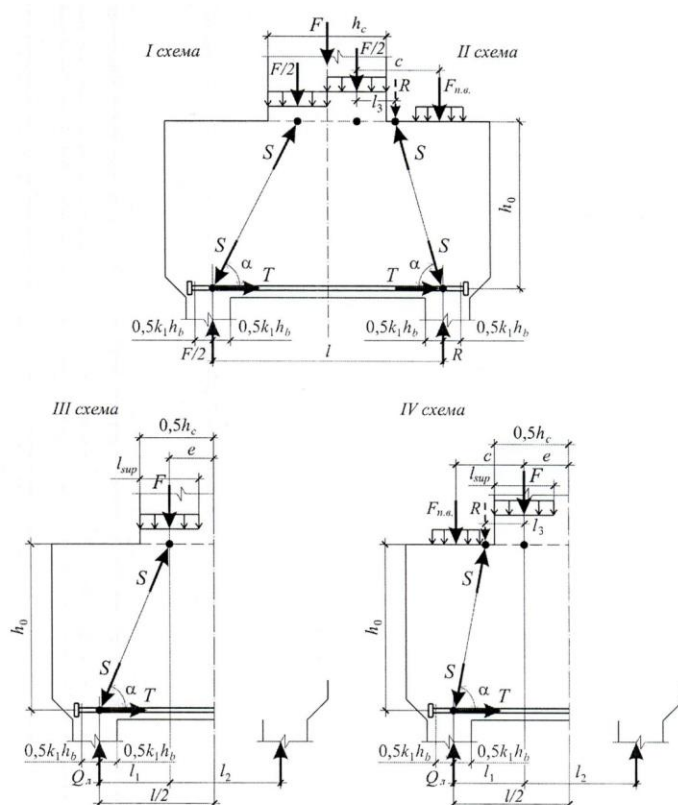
Расчетные аналоговые стержневые модели – АСМ подкрановых ригелей двухветвевых колонн при различных схемах нагружения
